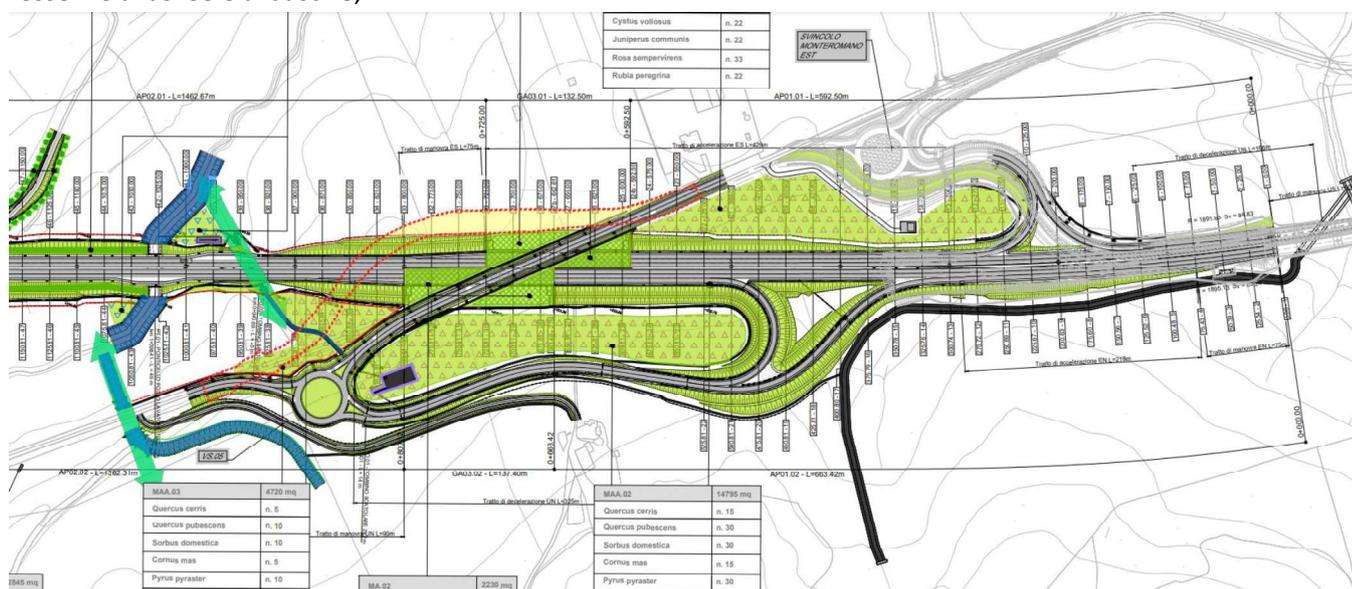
Stralcio planimetria di dettaglio interventi opere a verde (Tav. 1/2) T00IA01AMBPP03\_B
